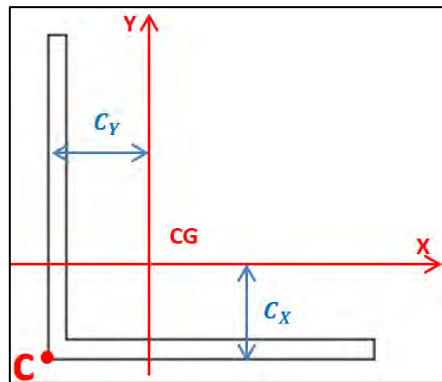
Perfil de los componentes de la estructura y centro de gravedad.
